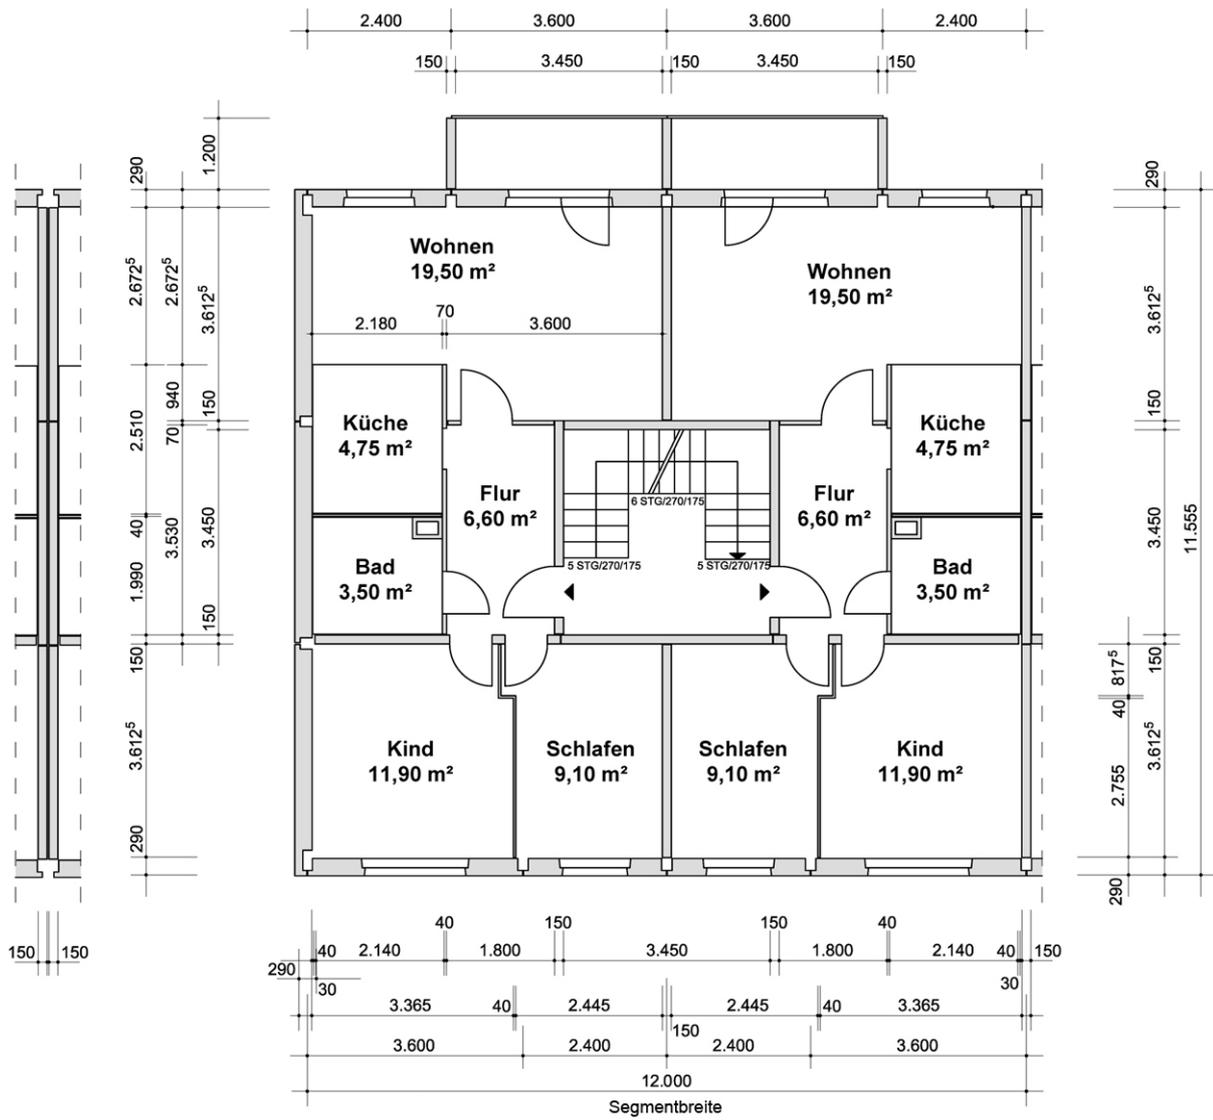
Grundriss Rand-/Mittelsegment (B: 12,00 m) – Normalgeschoss mit zwei 3-Raum-Wohnungen
